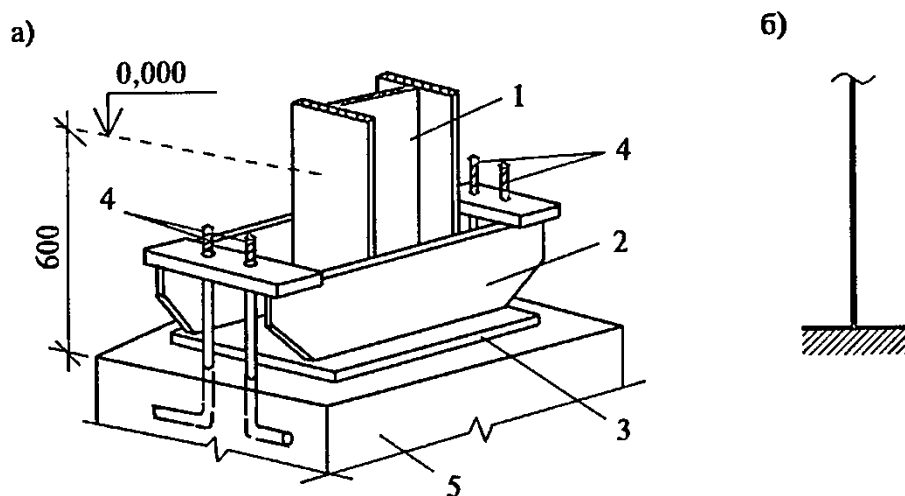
Жесткое крепление колонны к фундаменту: а) конструктивная схема;
